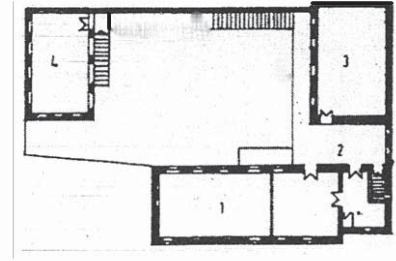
Eyvan Örneği, Hasan Süzer Evi, Bey Mahallesi, Gaziantep
